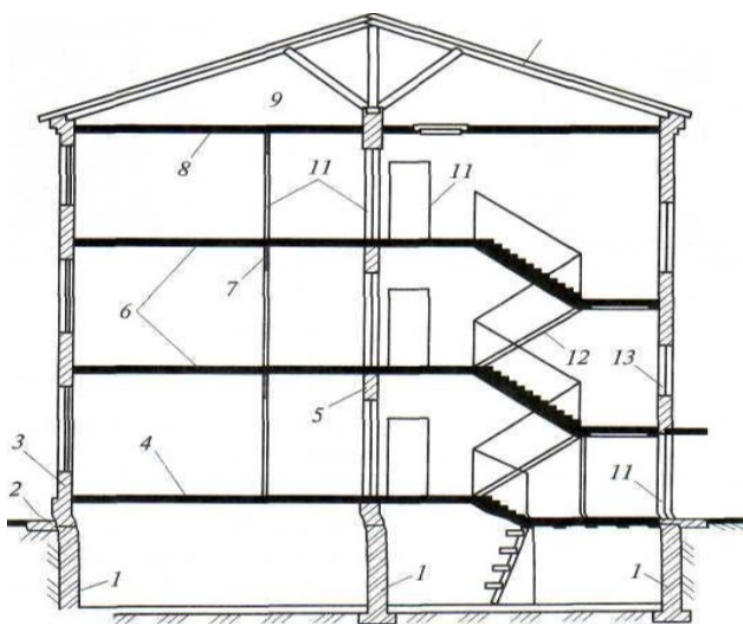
Поперечный разрез здания: 1 - фундамент; 2 — отмостка; 3 — наружные стены; 4 — надподвальное перекрытие; 5 — внутренние стены; 6 — межэтажные перекрытия; 7 — перегородка; 8 — чердачное перекрытие; 9 — чердак; 10 — крыша; 11 — двери; 12 — лестница; 13 — окно.
